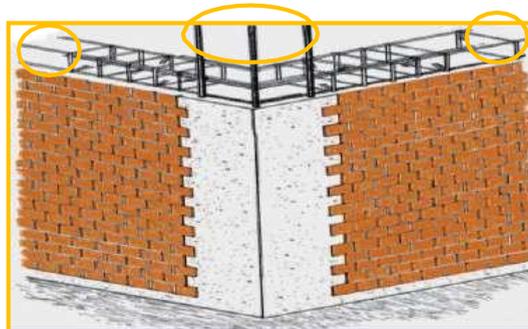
detalles de columnas y vigas de confinamiento
